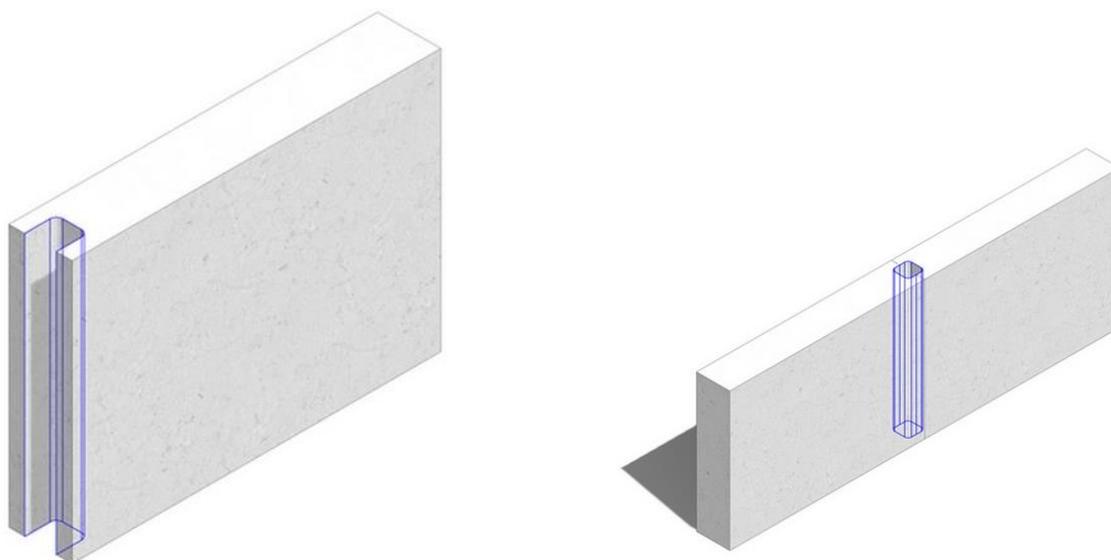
Réservations verticales : Piliers – Encadrements d'ouvertures.
